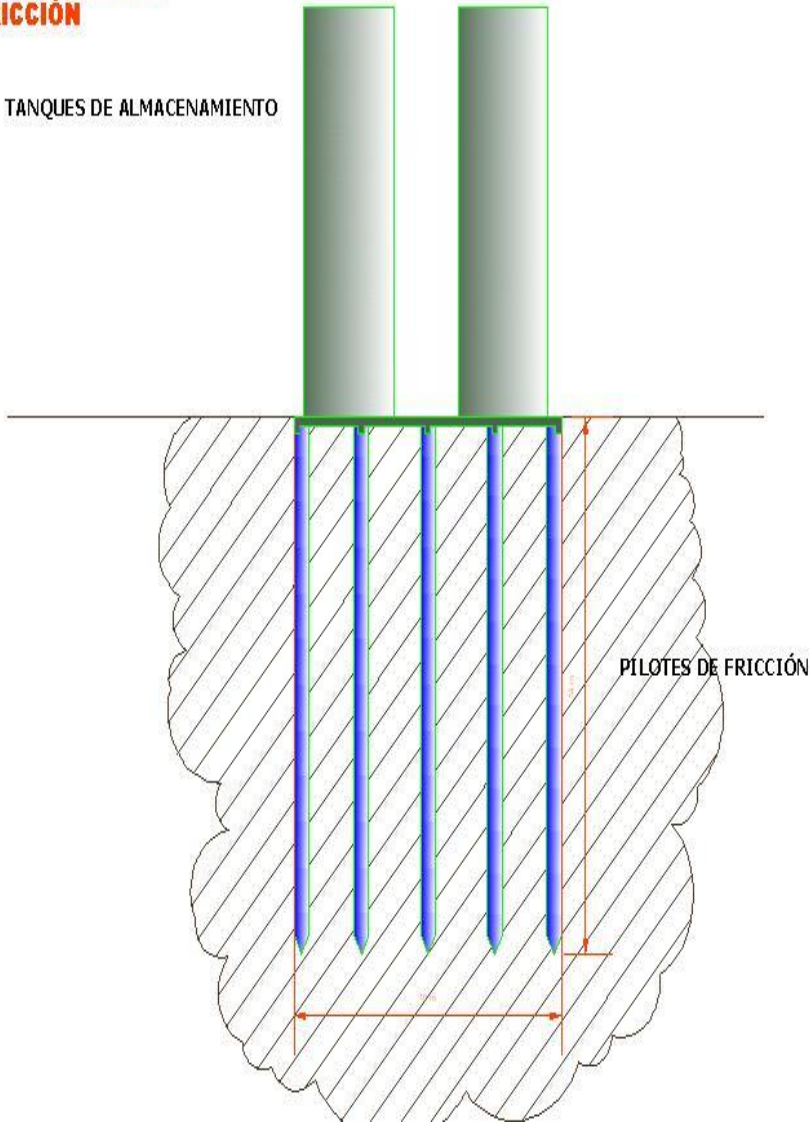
ALTERNATIVA DE CIMENTACION CON LOSA Y PILOTES.
